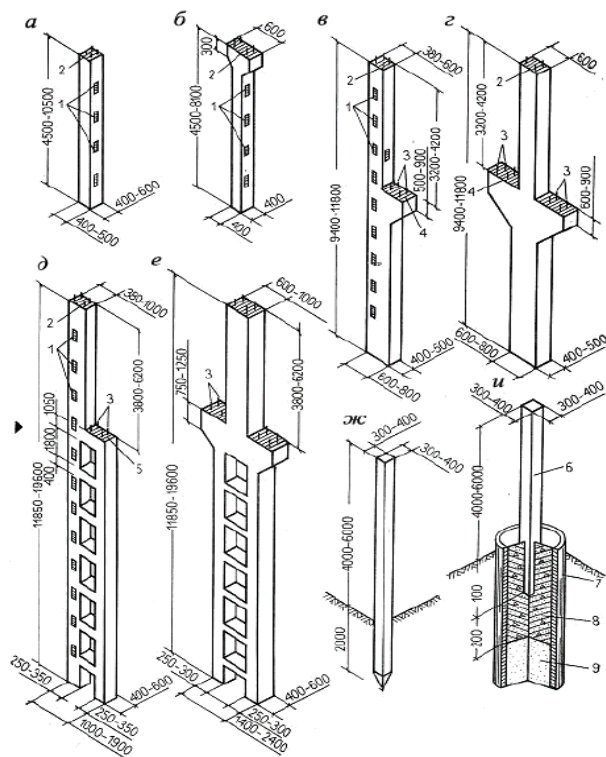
Типы железобетонных колонн: а – для крайних рядов бескрановых зданий; б – для среднего ряда бескрановых зданий; в – для крайнего ряда крановых зданий; г – для среднего ряда крановых зданий; д – двухветвевые для крайнего ряда крановых зданий; е – двухветвевые для среднего ряда крановых зданий; ж – сваи-колонны (целые); и – сваи-колонны (составные); 1 – закладные детали; 2 – стальной оголовок; 3 – анкерные болты; 4 – закладная деталь на поверхности консоли; 5 – закладная деталь на обреze колонны; 6 – колонна; 7 – цилиндрическая свая диаметром 700 мм; 8 – бетон марки 200; 9 – уплотненный грунт
